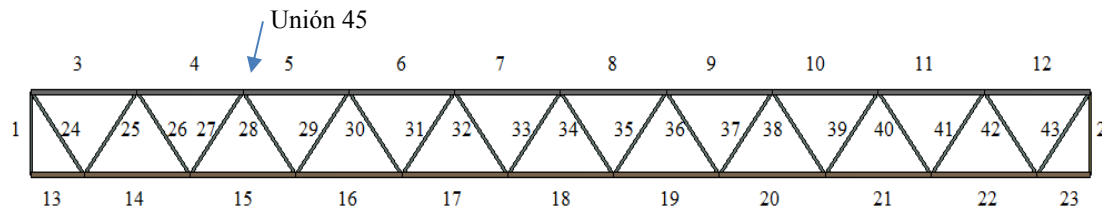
Armadura tipo Warren de sección tubular cuadrada.
